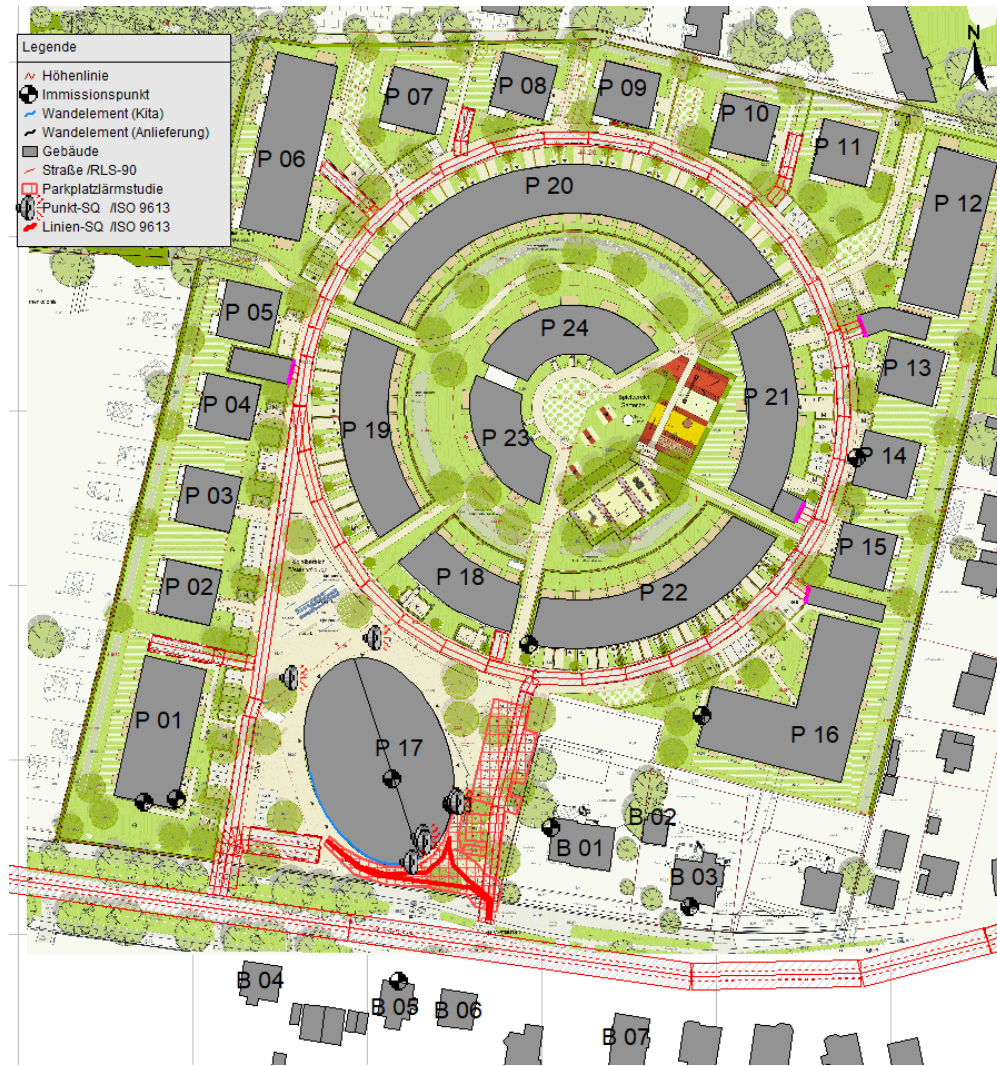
Übersichtslageplan mit Geometrie der Berechnung und Gebäudebezeichnung (Wölfel 2018)
